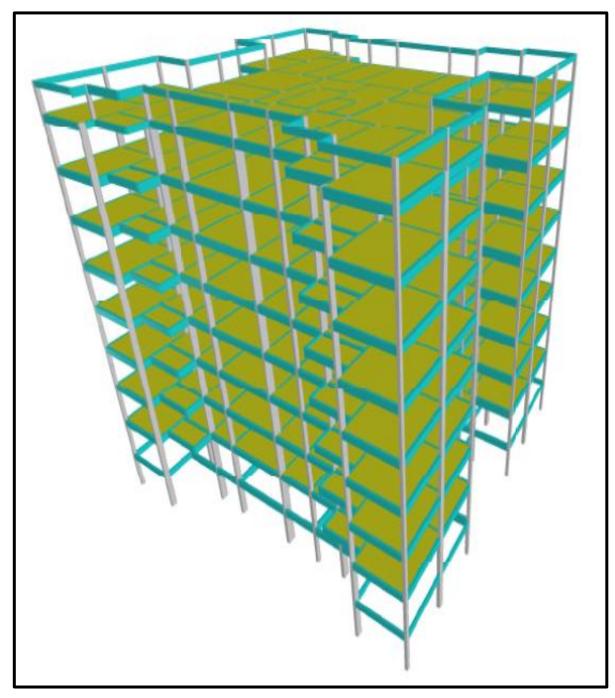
Modelo da estrutura em concreto armado. (Fonte: Eberick, 2014).
